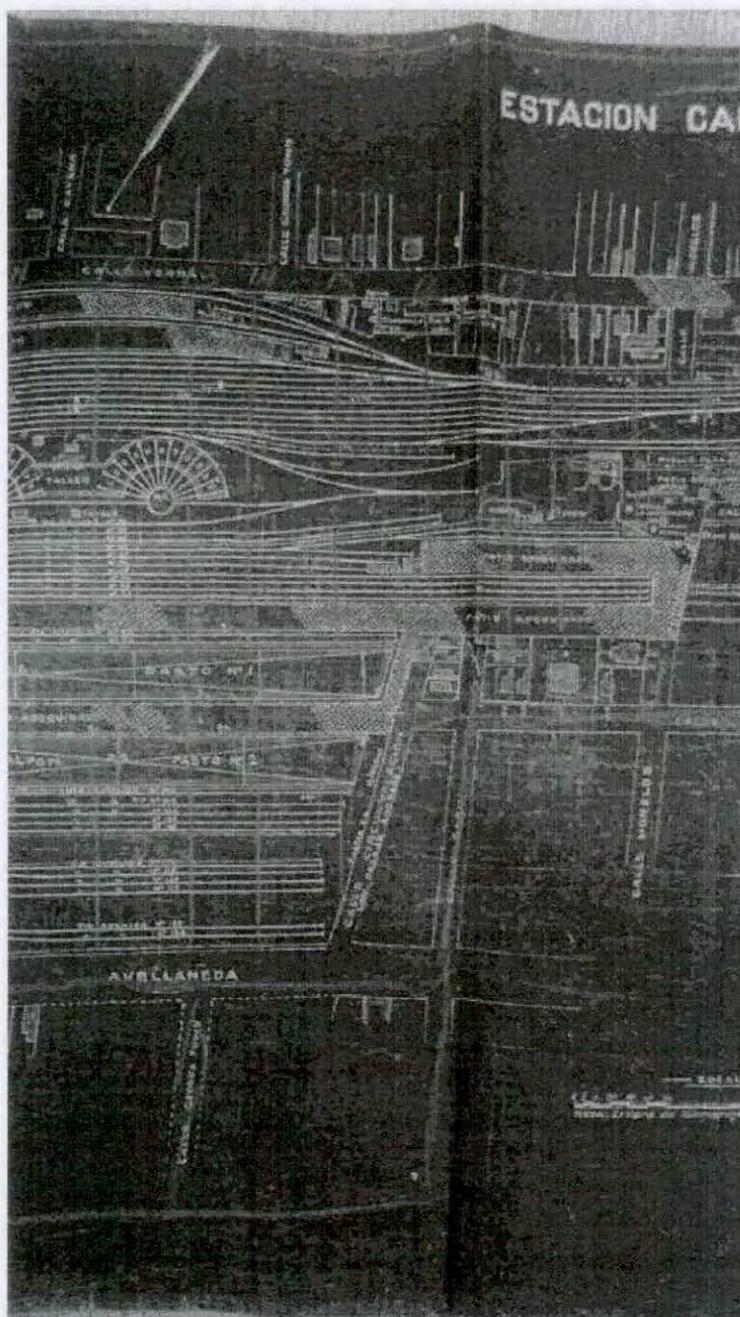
Plano PF Caballito de 1926 / sector 5
